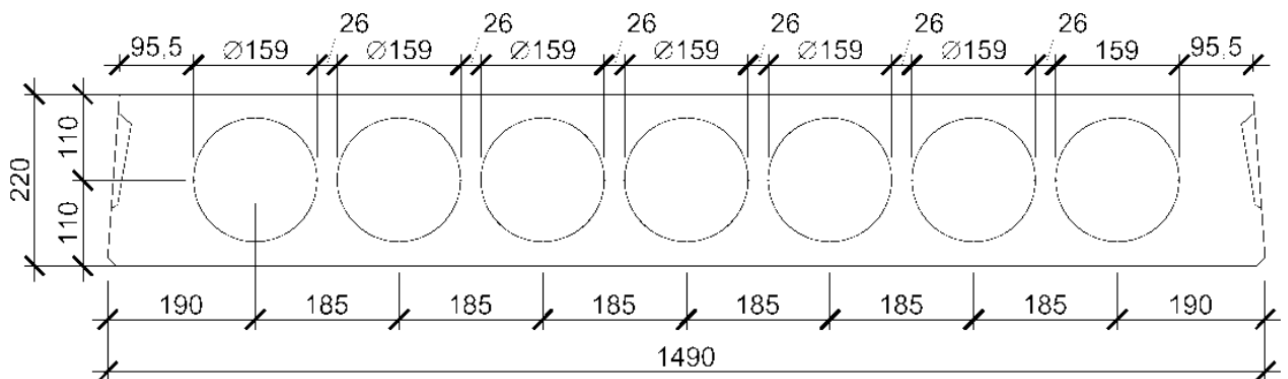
Розріз залізобетонної плити перекриття
